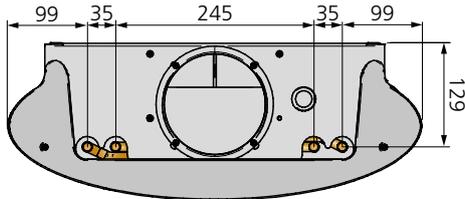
Dimensions ADRIATIC Ellips, vue arrière du raccordement hydraulique
